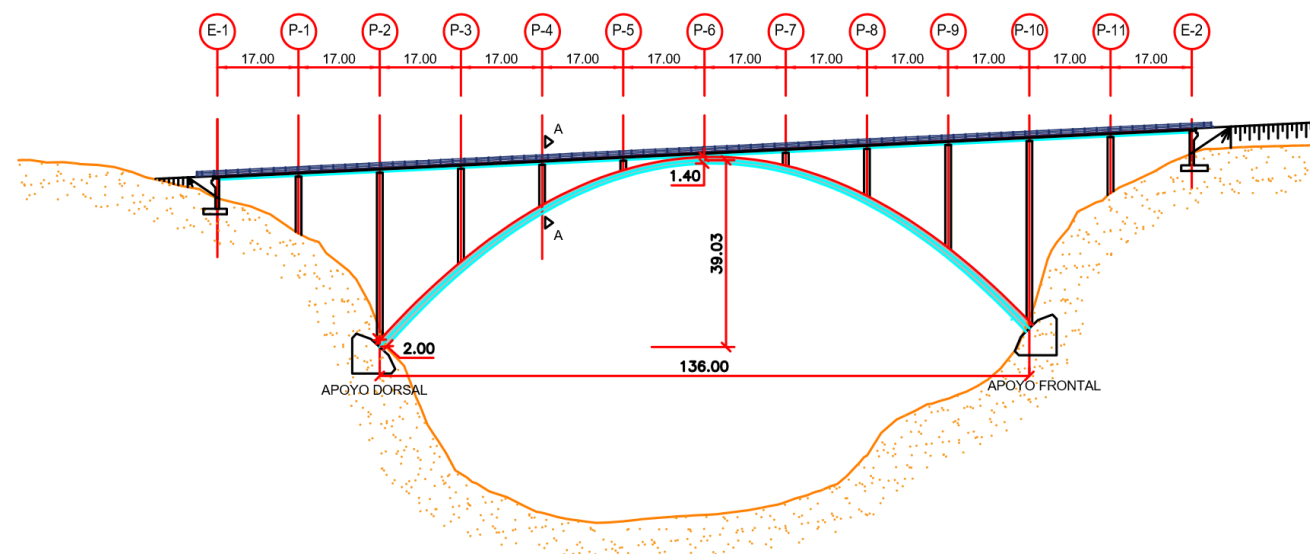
Sección del puente de la alternativa 2 (Fuente: AutoCAD)
